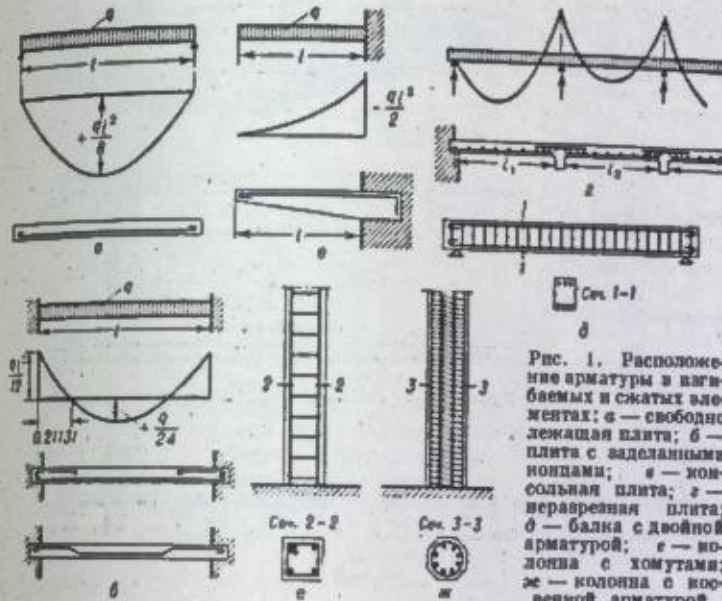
Расположение арматуры в изгибаемых и сжатых элементах: а — свободно лежащая плита; б — плита с заделанными концами; в — консольная плита; г — неразрезная плита; д — балка с двойной арматурой; е — колонна с хомутами; ж — колонна с косвенной арматурой.
